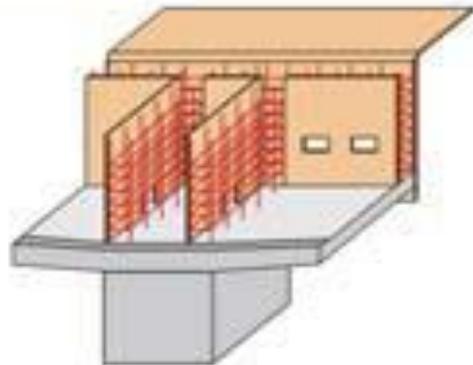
Fase 1. Encofrado y armado de losa inferior
